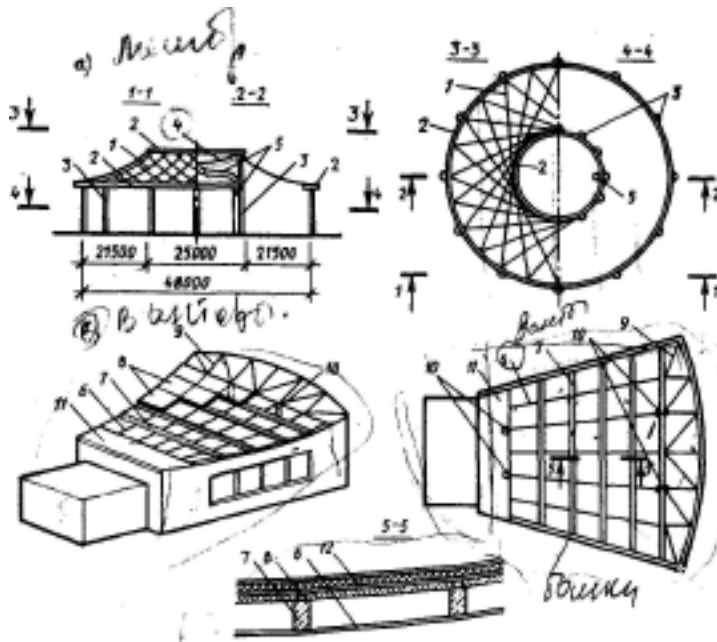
Типы пригруженных покрытий: а 1- покрытие *шо* В. Г. Шухова (1898 г.); б 2- покрытие из вант, балок и железобетонных плит (ФРГ, 1950 г.); 1 — сетка из металлических полос; 2 — опорные кольца; 3 — стойки; 4 — провисающая мембрана; 5 — водоотвод; 6 — ванты; 7 — балки; 8 — сборные железобетонные плиты; 9 — ферма, воспринимающая распор от вант и передающая его на боковые стены; 10 — колонны под нижним поясом горизонтальной фермы; 11 — плита, воспринимающая распор от вант и передающая его на боковые стены; 12 — кровля
